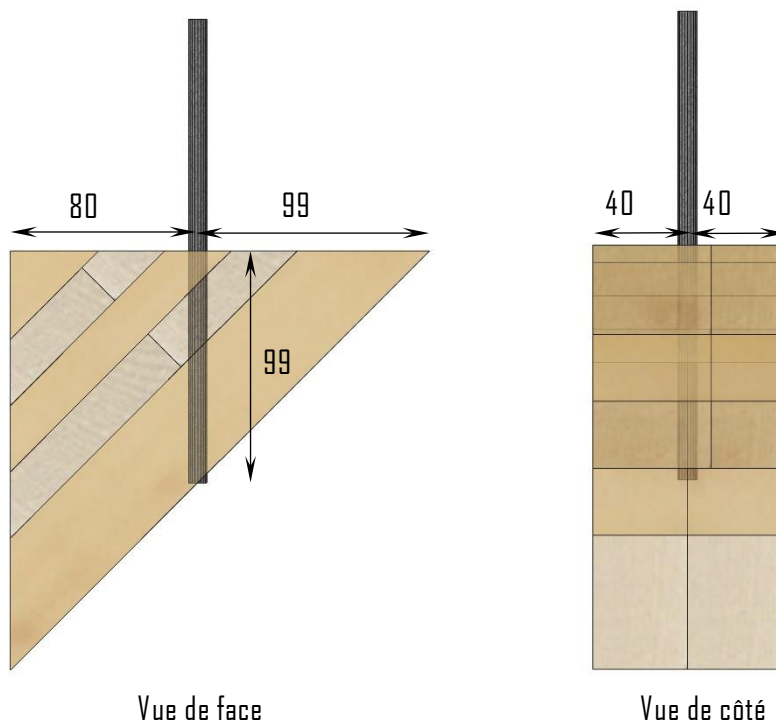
Dimensions des éprouvettes d'arrachement
